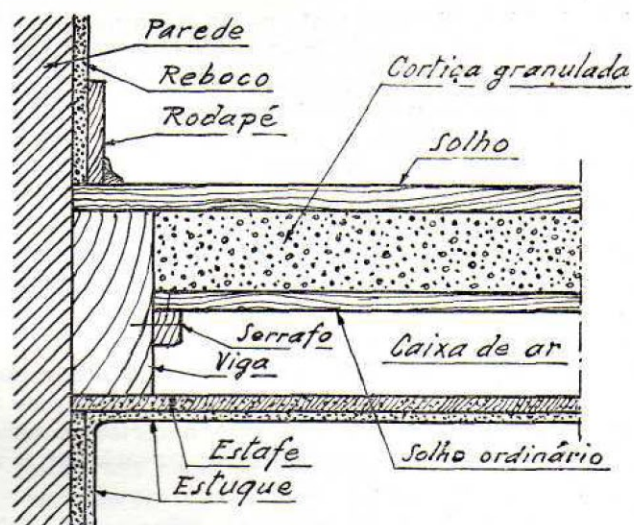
PAVIMENTO E TECTO PROTEGIDOS
